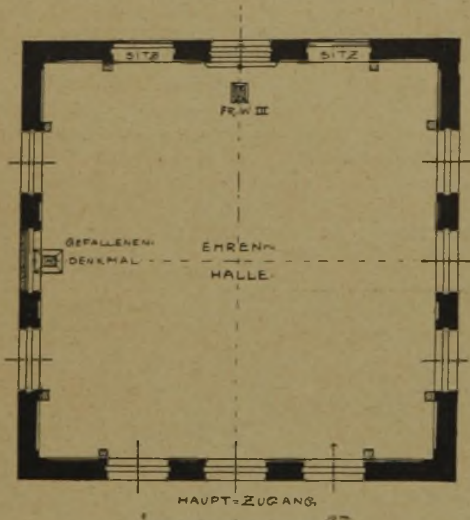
Grundriß der Ehrenhalle (1 : 400).
